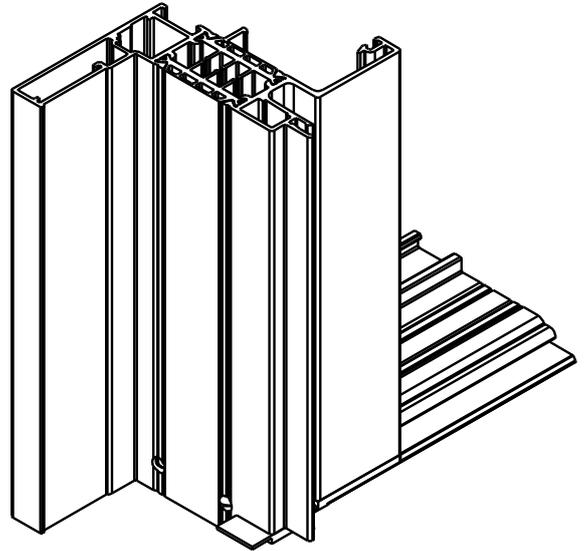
DETAILS D'ASSEMBLAGE DORMANT EN PARTIE BASSE
